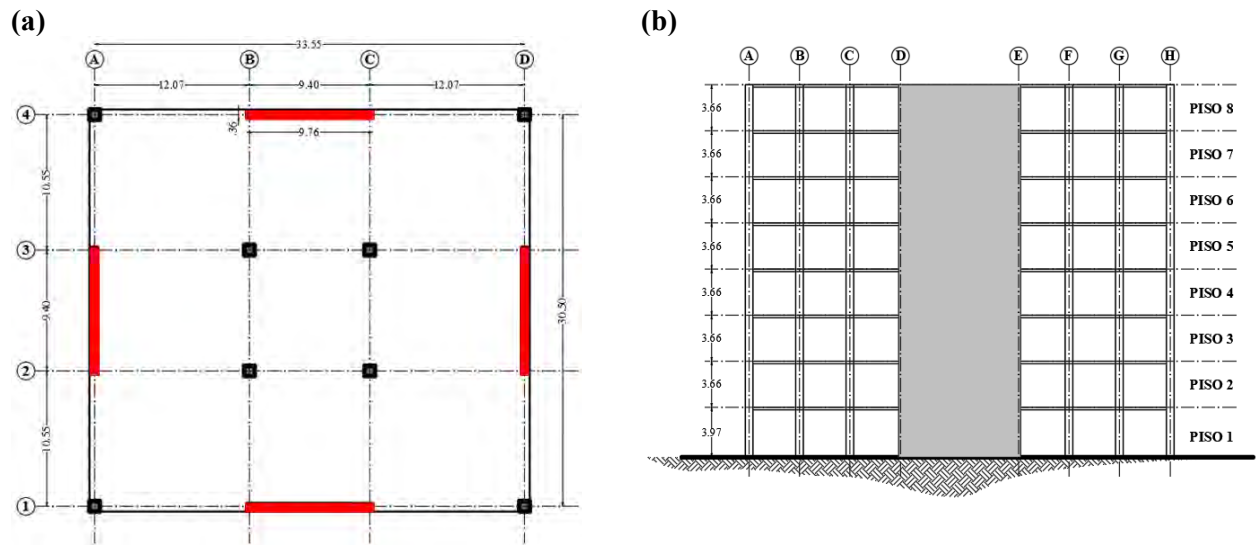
Planta y alzado de los arquetipos de 8 pisos (medidas en metros).
